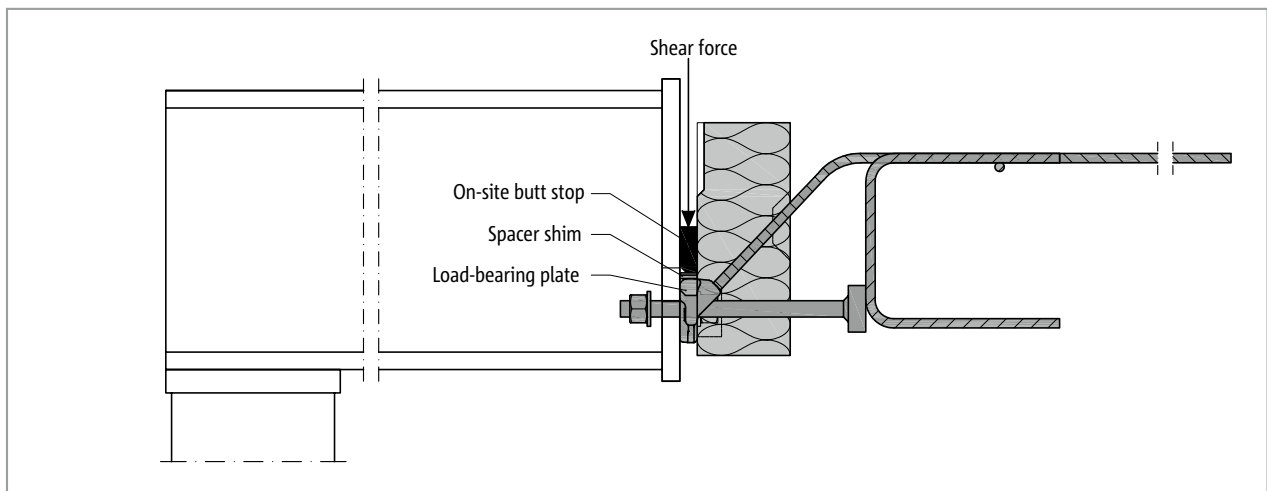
Schöck Isokorb® T type SQ: On-site butt stop for transferring shear forces
